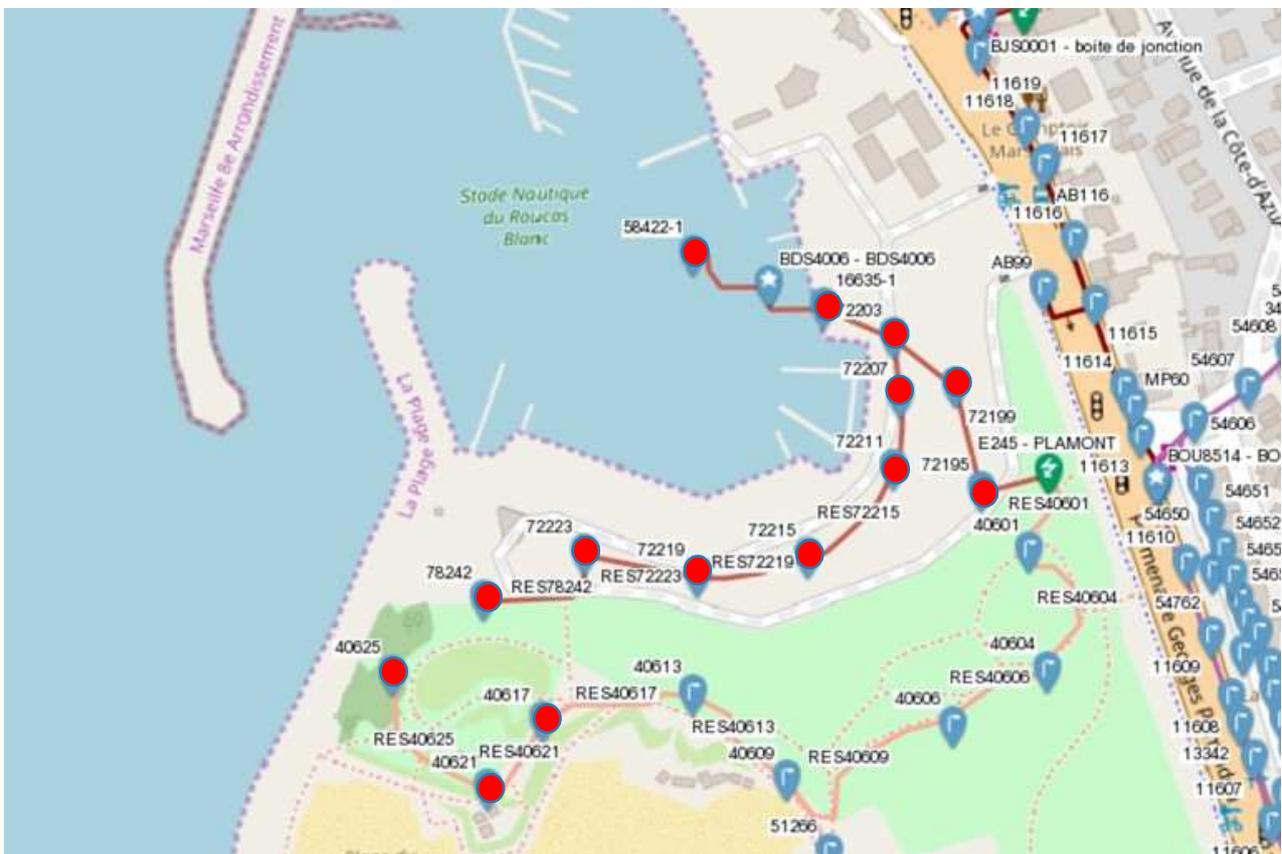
Plan DT SNEF – MARSEILLE – Arrondissement 8 – GEORGES POMPIDOU
